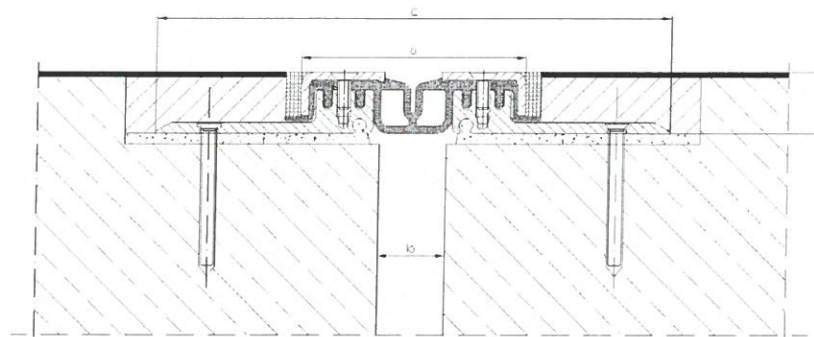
CONECTO PARK GA 43.10.90& S waterproof expansion joint profile
